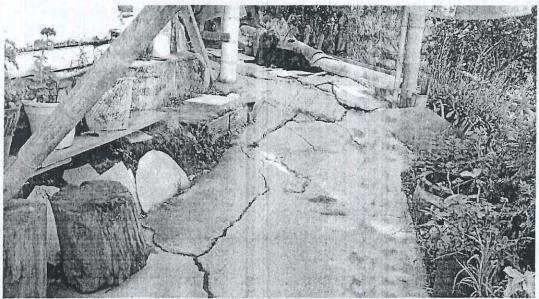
Agrietamiento en losa de concreto - Patio de vivienda.
